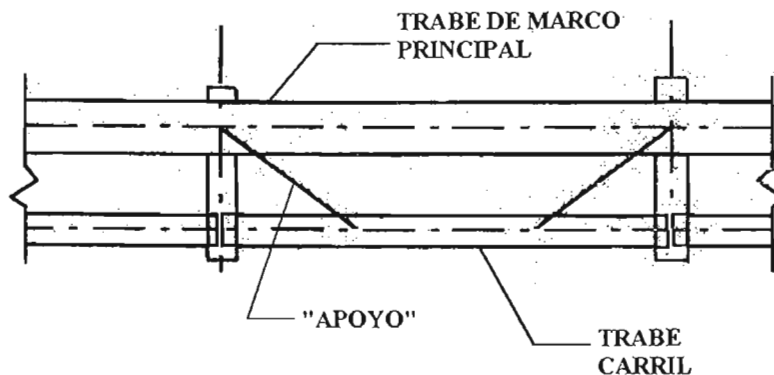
Vista en planta de una trabe carril acompañada de "apoyos" horizontales.
